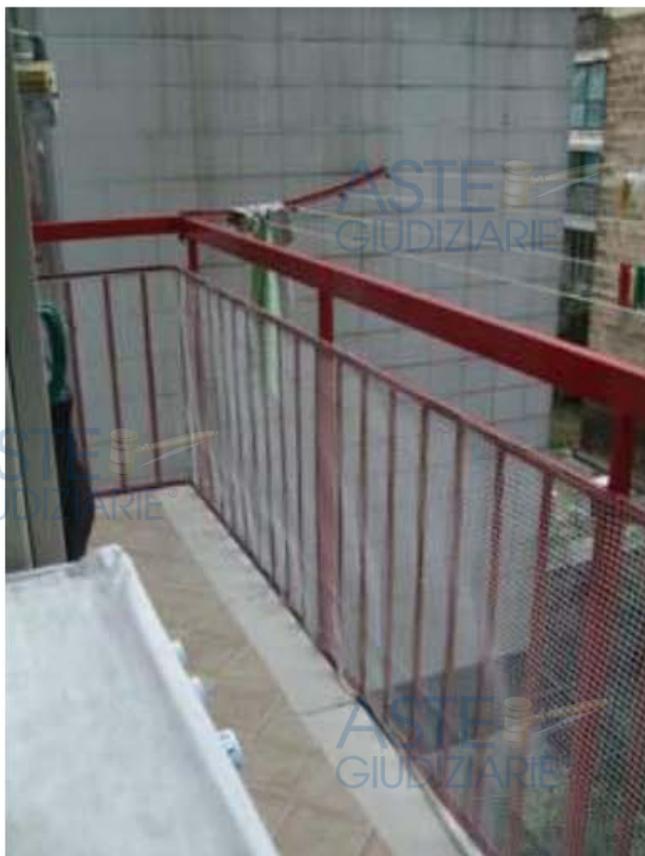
Balcone che si affaccia sull'atrio interno, dove è posta la caldaia a gas metano, i balconi hanno tutti ringhiere in ferro, con pavimentazione in gres ceramico.
